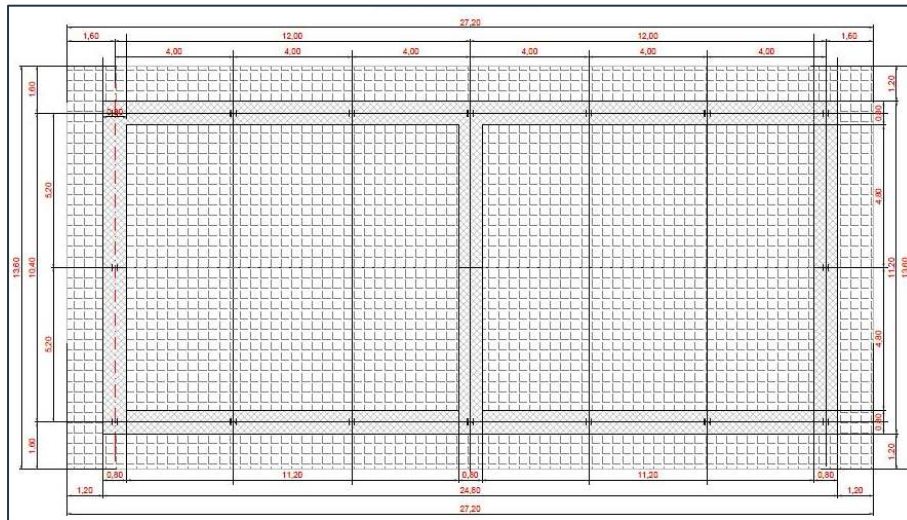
pianta fondazioni edificio ricovero mezzi agricoli
